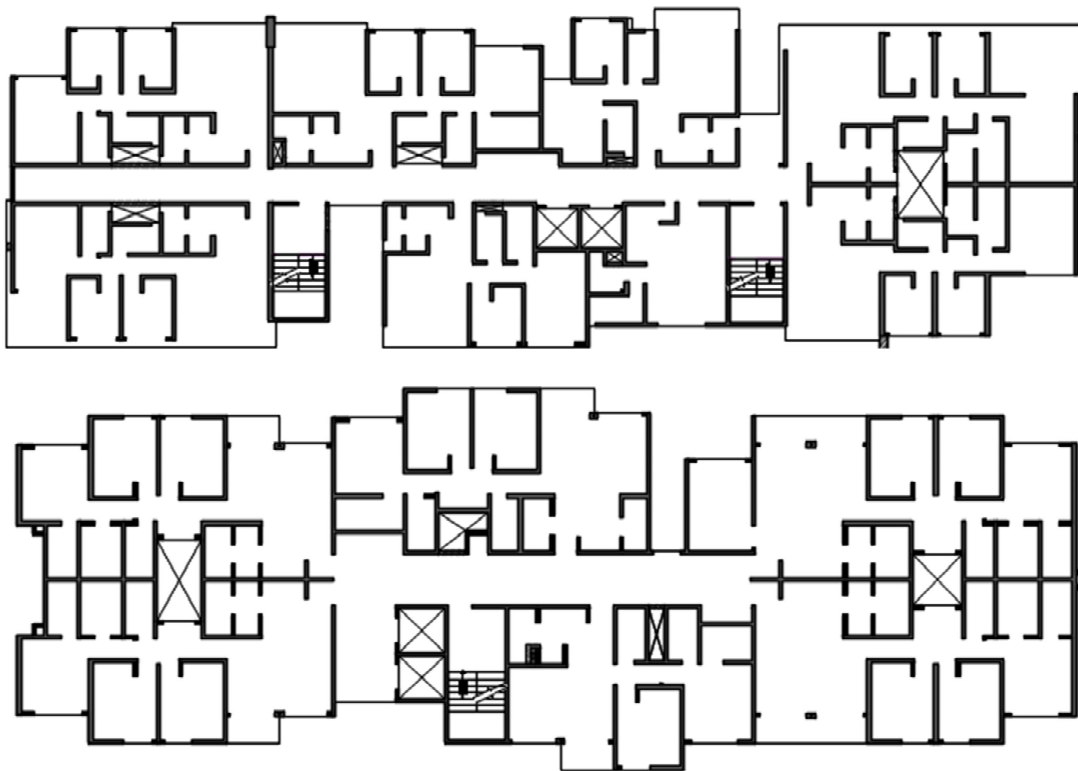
Plantas típicas de edificaciones con sistema de muros. Fuente: Imágenes de planos DUAL INGENIERÍA ESTRUCTURAL SAS. Archivo personal, recuperado en el 2017.
